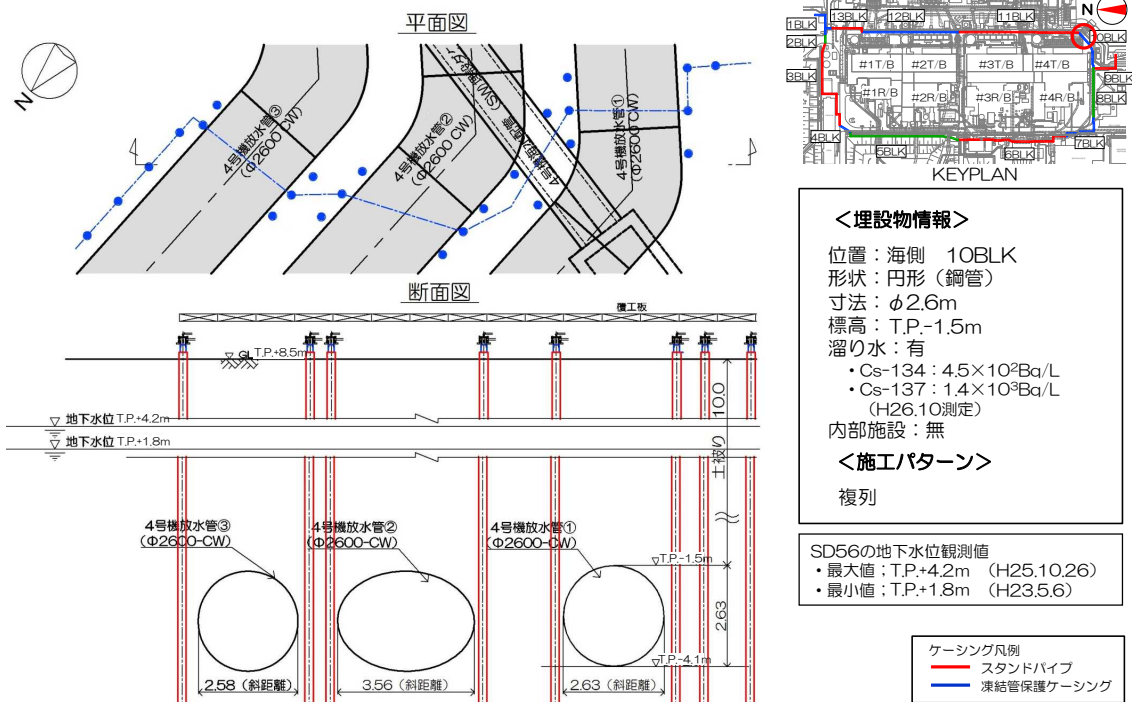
【10-3】4号機放水管①②③ 施工方法(複列施工)
